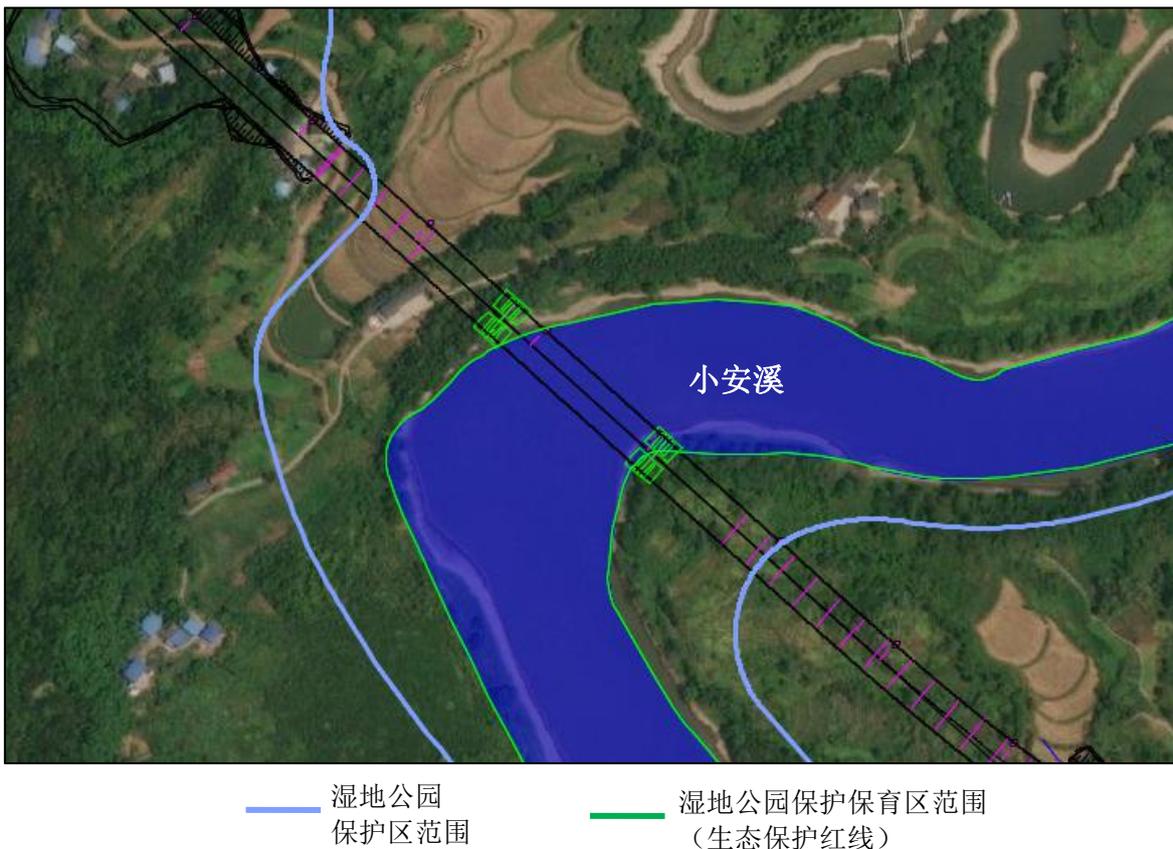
拟建公路小安溪大桥桥型平面图（局部）
